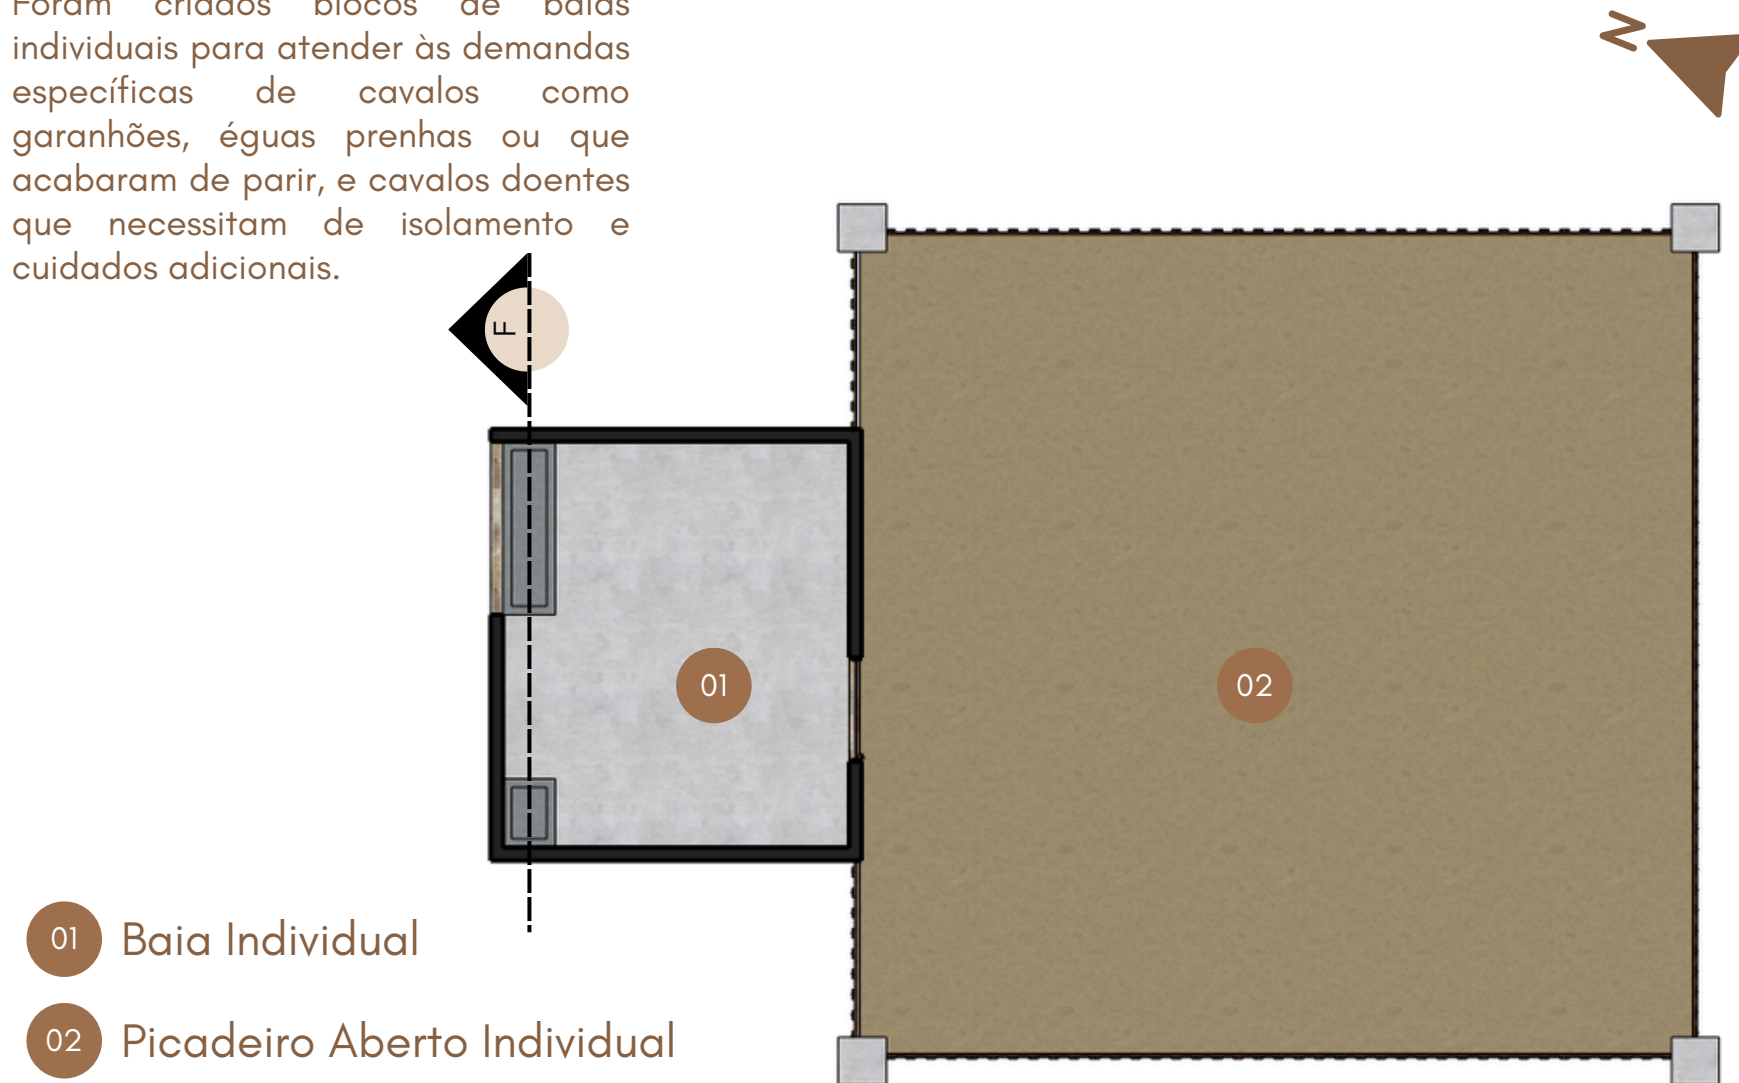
Planta Baia Individual / Fonte: Elaborado pela autora em 2024
